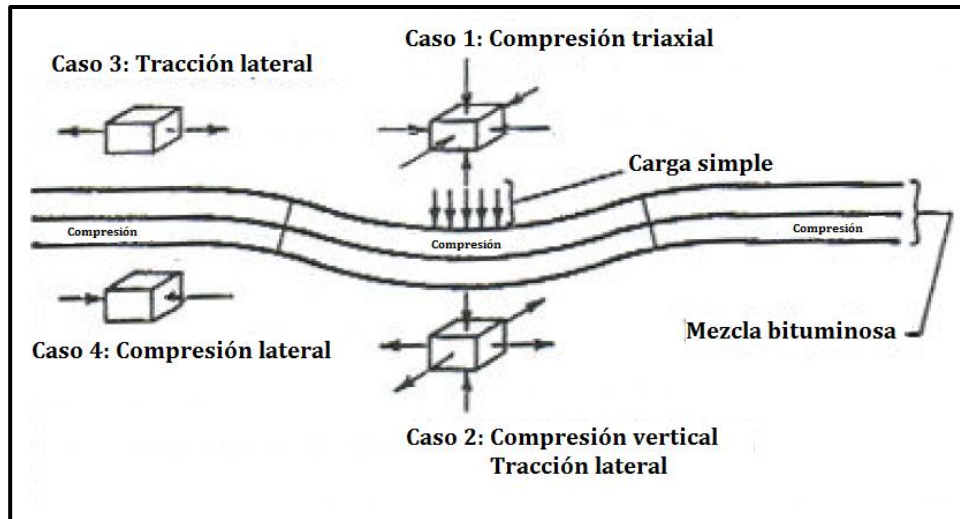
Estado de tensiones en pavimento bajo una carga simple.
